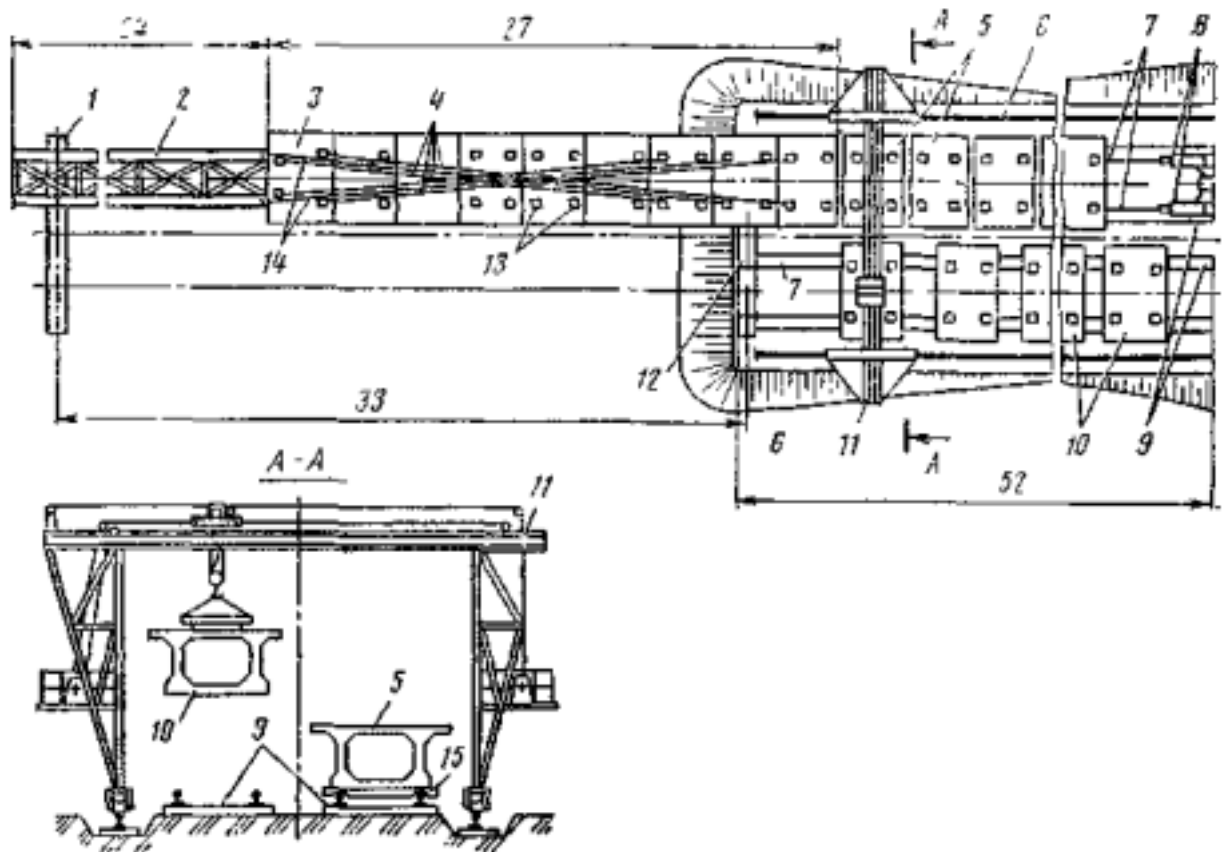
Майданчик для укрупнювального збирання залізобетонних балок: 1 – опора моста; 2 – аванбек; 3 – перша секція балки, 4 – верхні напружані пучки балки; 5 – блоки другої секції, 6 – рейковий шлях крана; 7 – рейковий шлях стенду; 8 – штовхаючий домкрат; 9 – складальний стенд; 10 – готові блоки; 11 – козловий кран; 12 – берегова опора моста; 13 – анкерні упори напружуваних пучків; 14 – кріплення аванбека до балки, 15 – санки.
